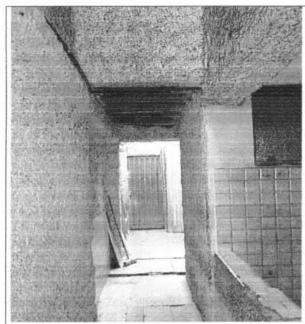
Costado sur del inmueble, aparentemente sin daños estructurales.
